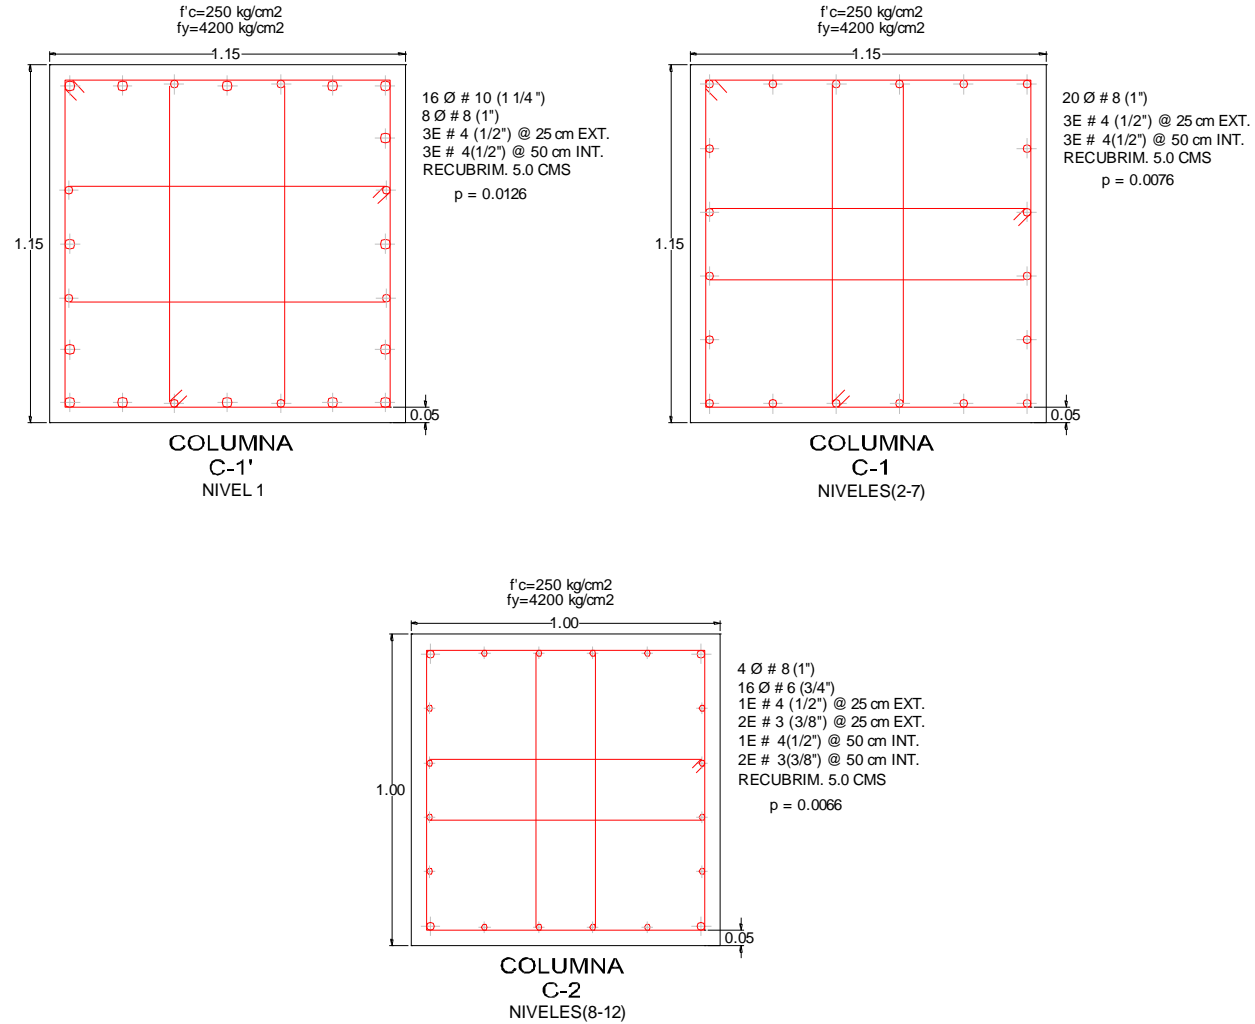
Detallado de armado de columnas del marco de 12 niveles con base a la hipótesis de las NTCC-17.
